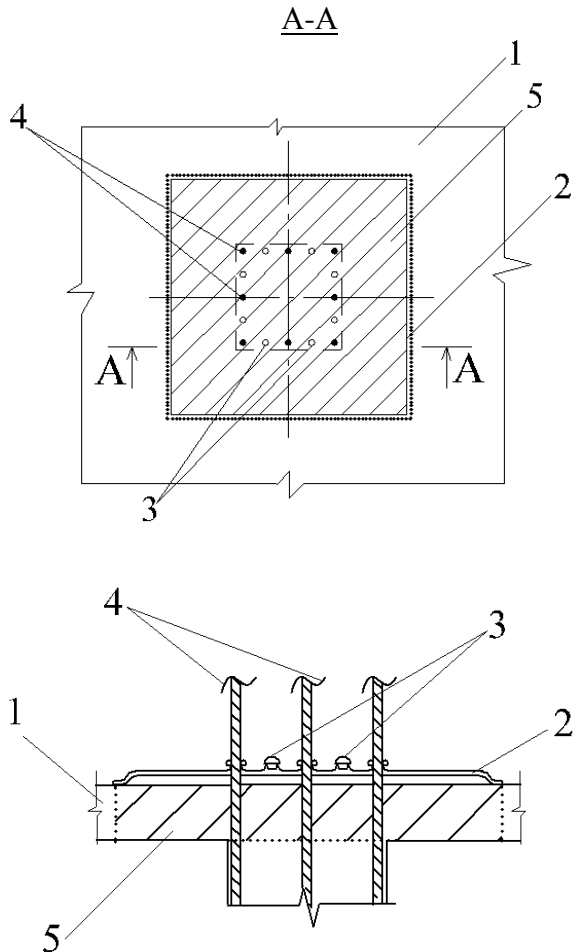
Уплотнение бетонной смеси на густоармированных участках с помощью вакуумирования.
